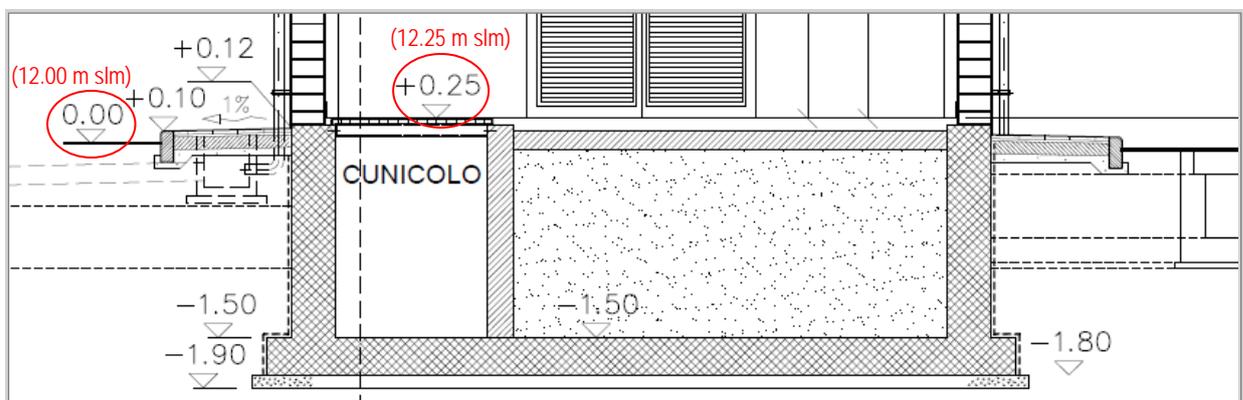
Fabbricato cabina elettrica MT – Particolare di sezione piano terra (Rif. [10])
